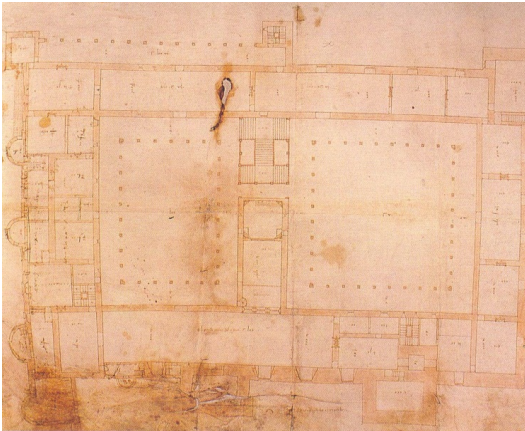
Alonso de Covarrubias, Planta principal del Alcázar.1536. Madrid, Ministerio de Asuntos Exteriores
